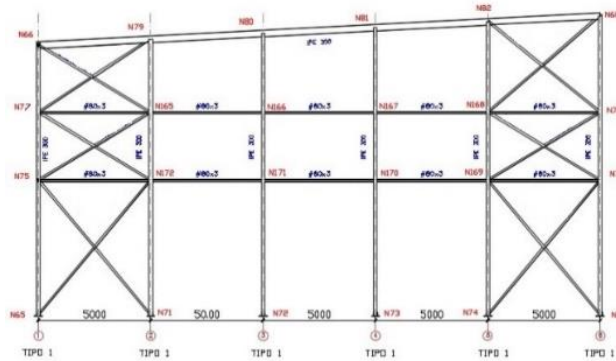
Pórtico Fachada N. (Fuente: Creación propia)
